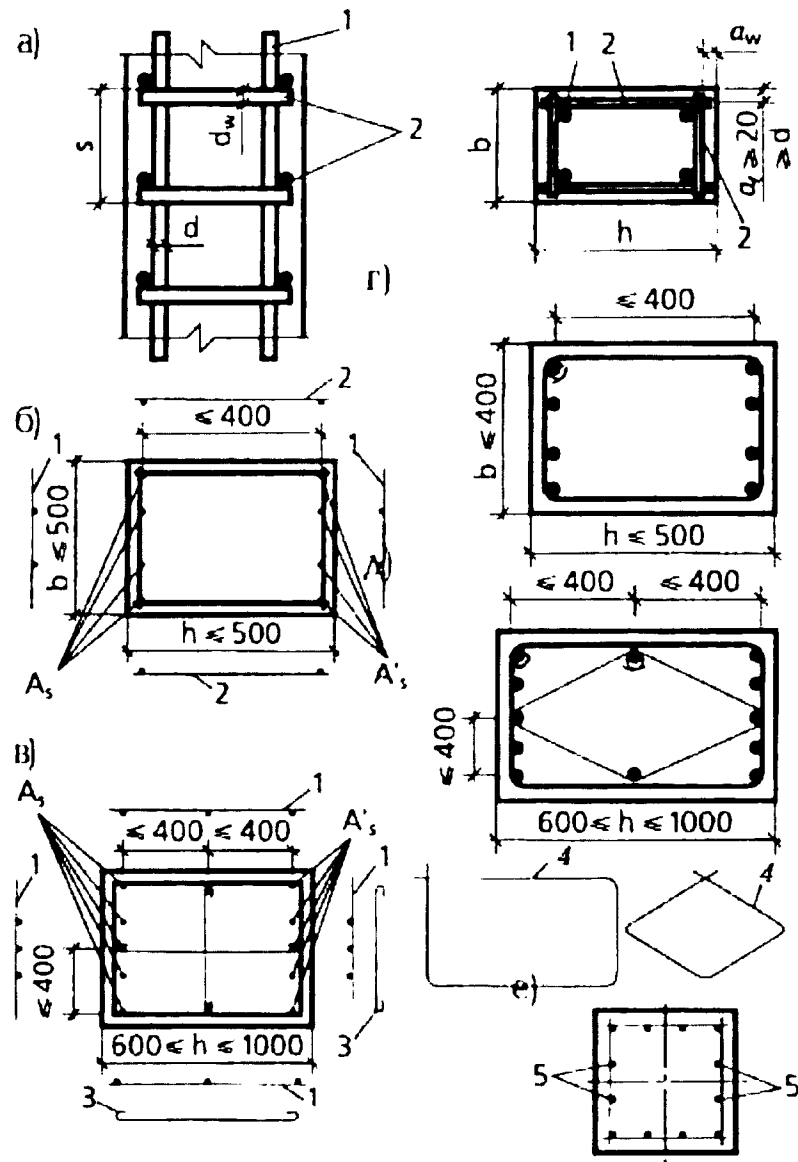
Армирование сжатых элементов с гибкой арматурой:
